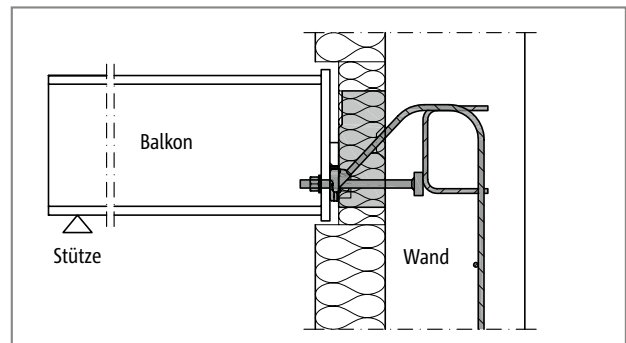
Schöck Isokorb® T Typ SQP-WU: Sonderkonstruktion; erforderlich bei Anschluss an eine Stahlbetonwand
